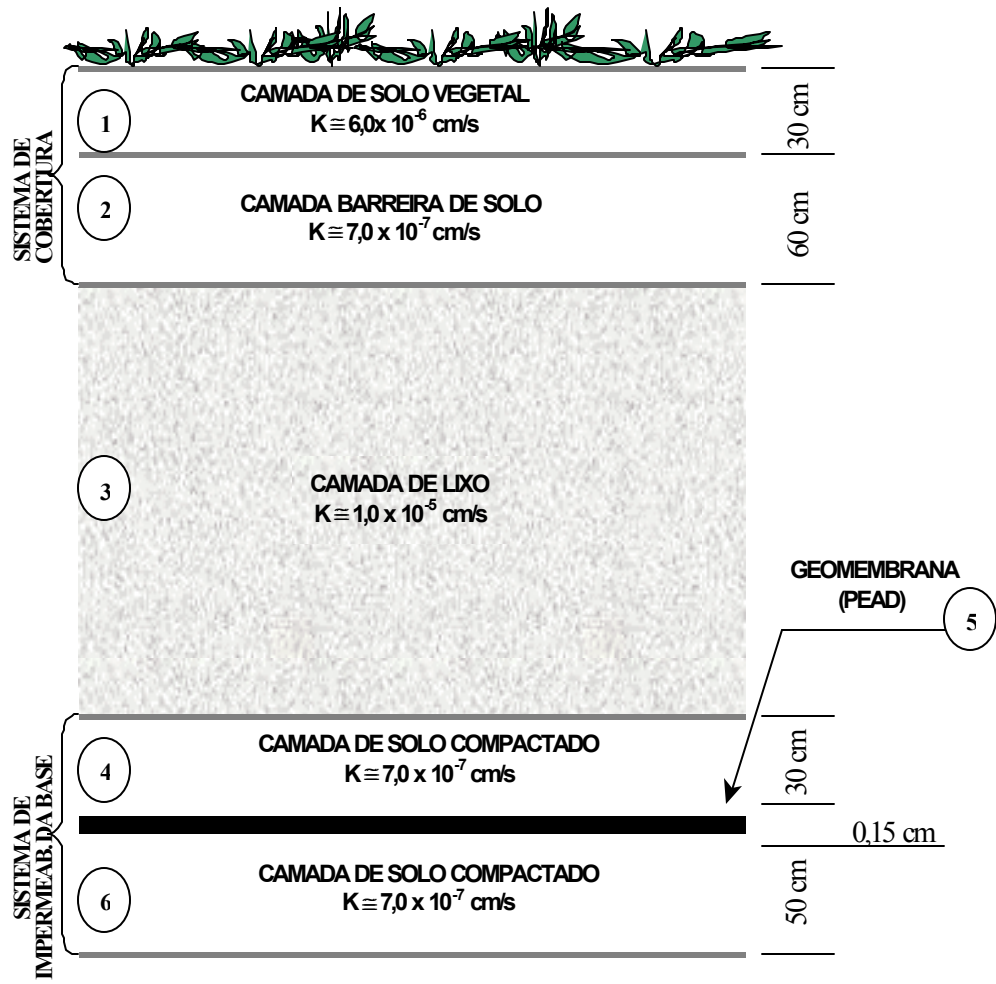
Perfil esquemático do aterro sanitário de Presidente Prudente.
